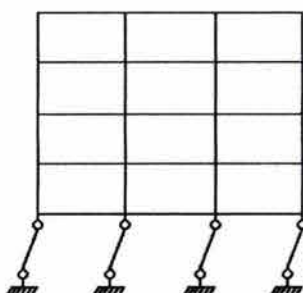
Figura V.I. Posible mecanismo de colapso de edificios con Planta Baja Débil
